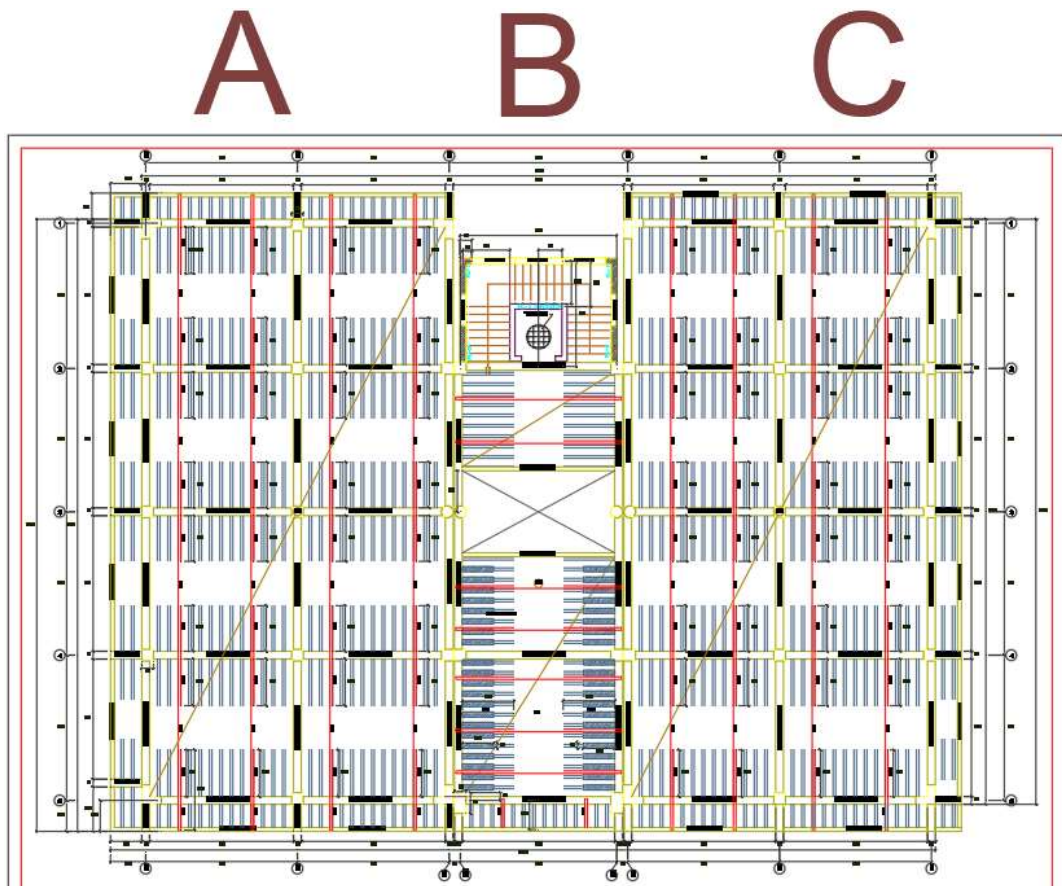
Vista en planta de los elementos estructurales del proyecto de edificación
